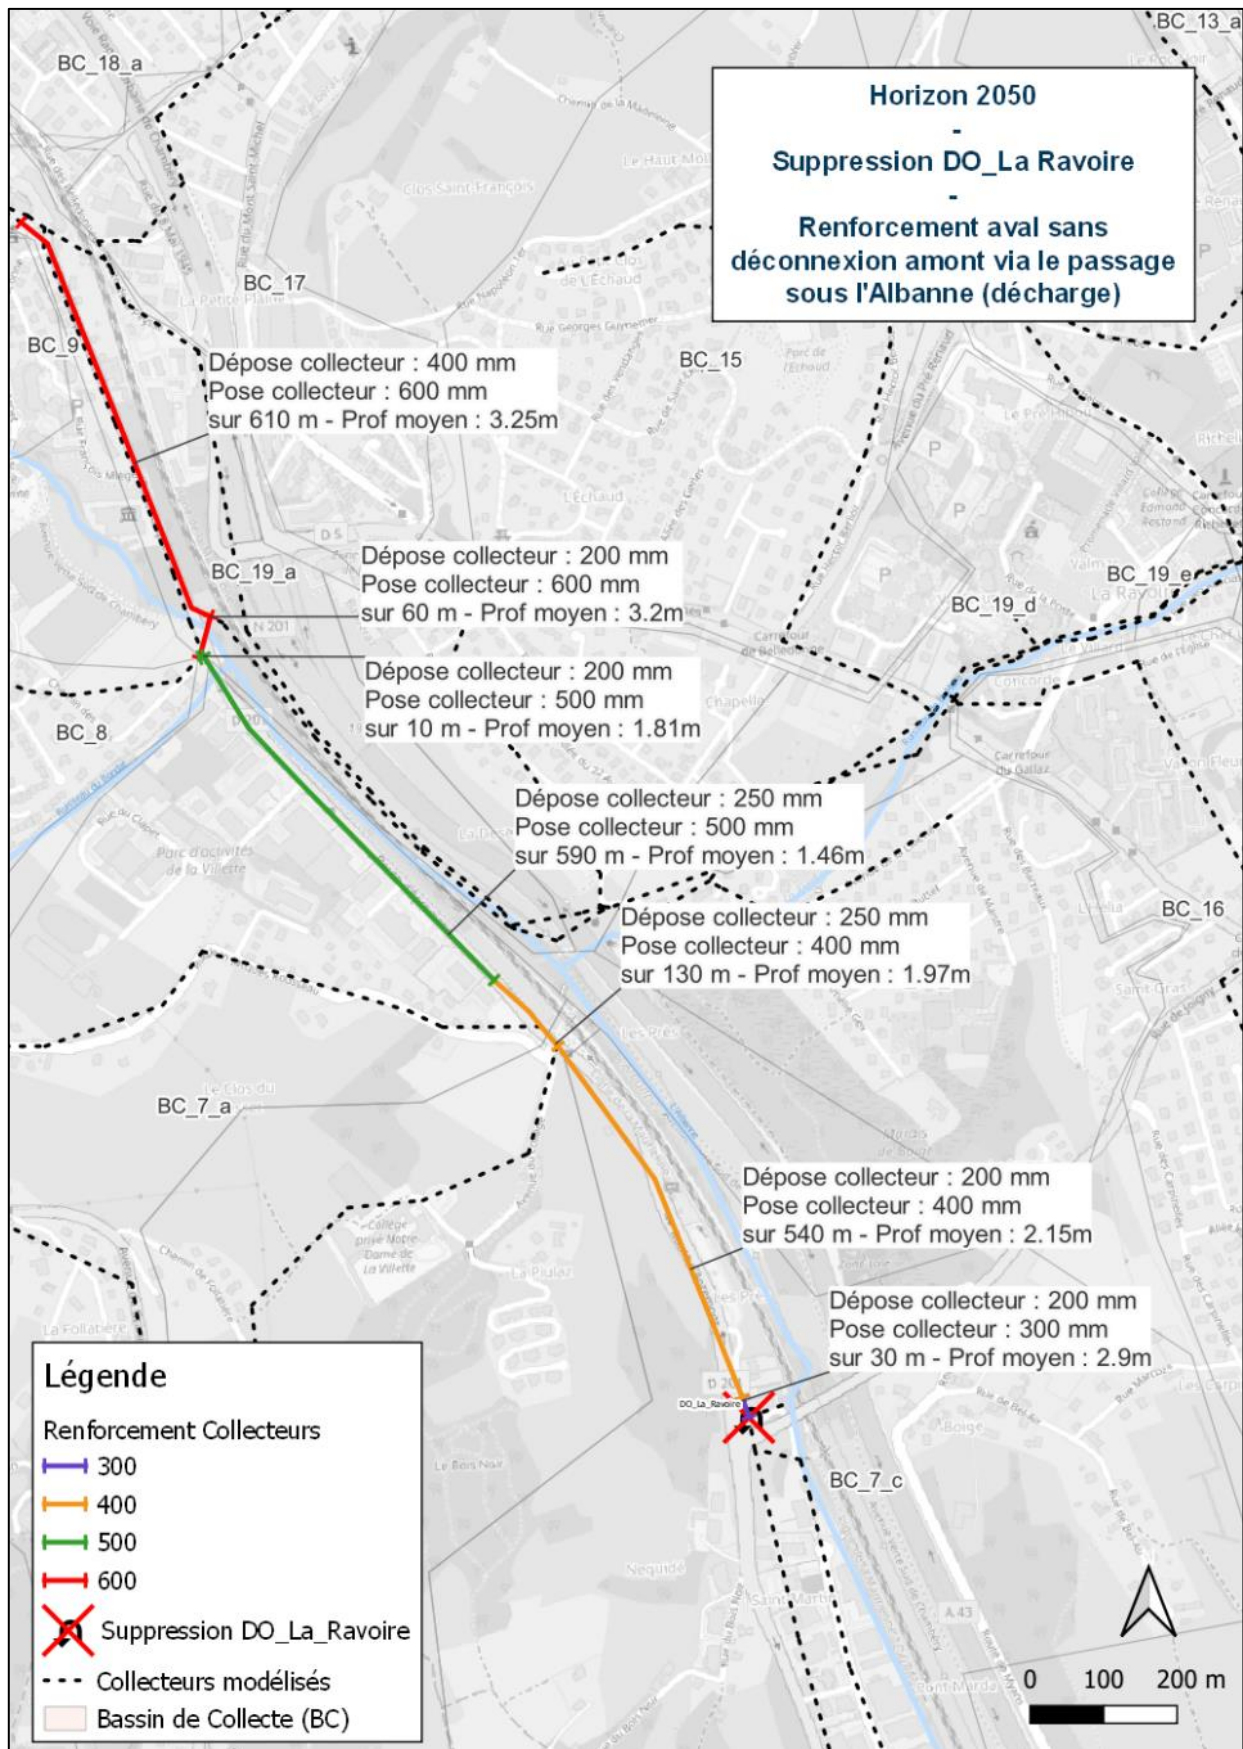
Renforcement des collecteurs - Suppression DO La Ravoire – aménagement 2
